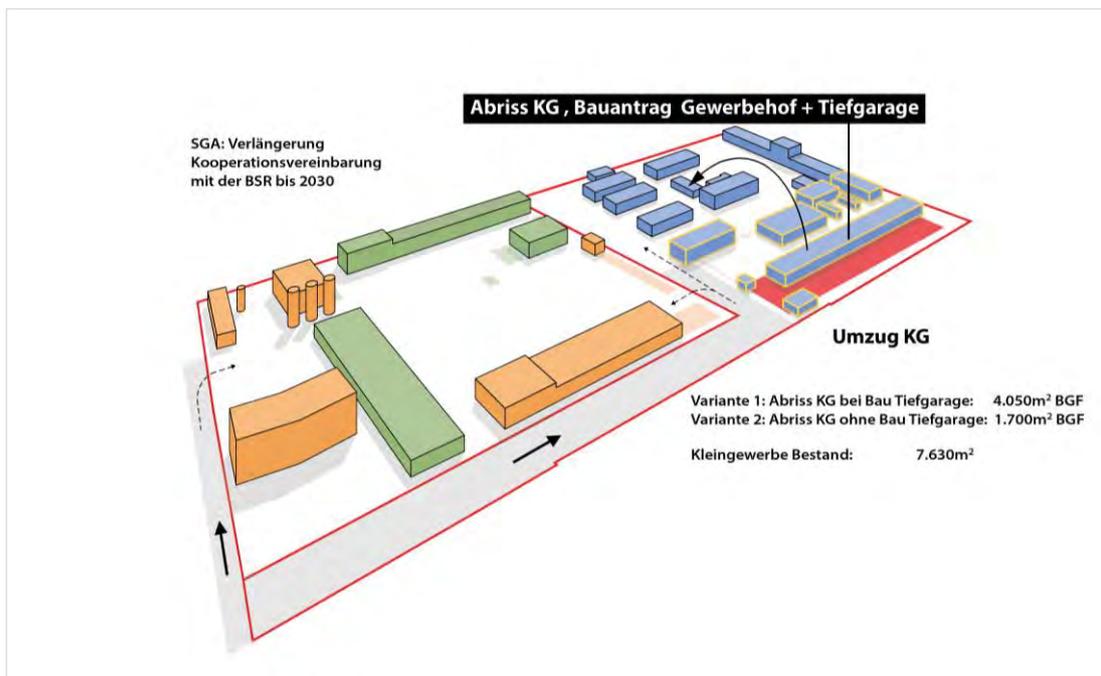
Bauantrag Neubau Kleingewerbe, Abriss Bestandsgebäude Kleingewerbe
